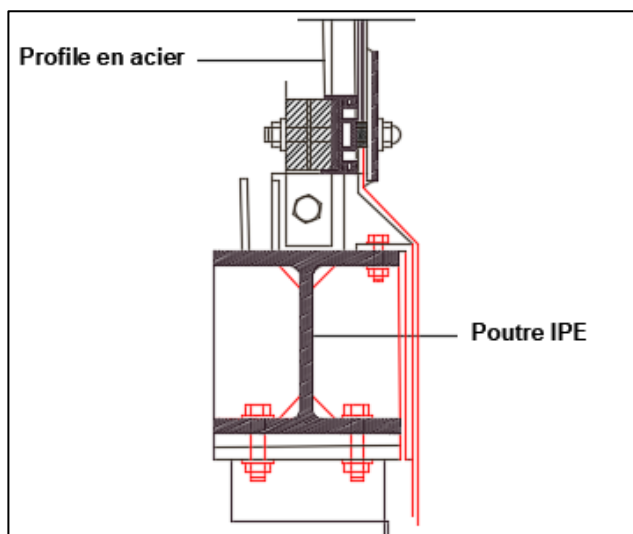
détail de raccordement de poteau et poutre métallique Source : auteurs
